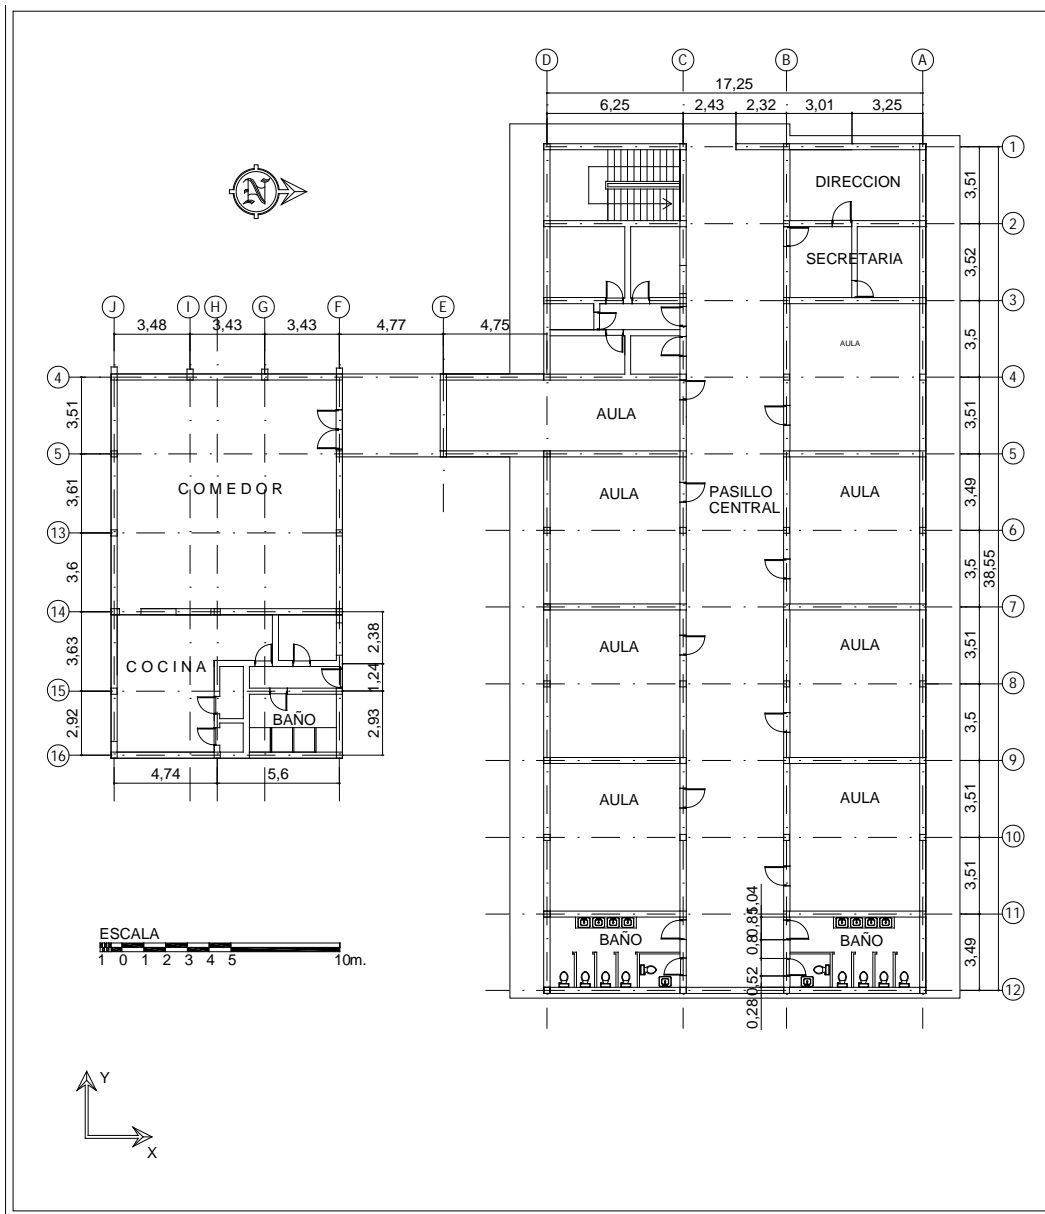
Plano de arquitectura de la planta baja del edificio.
